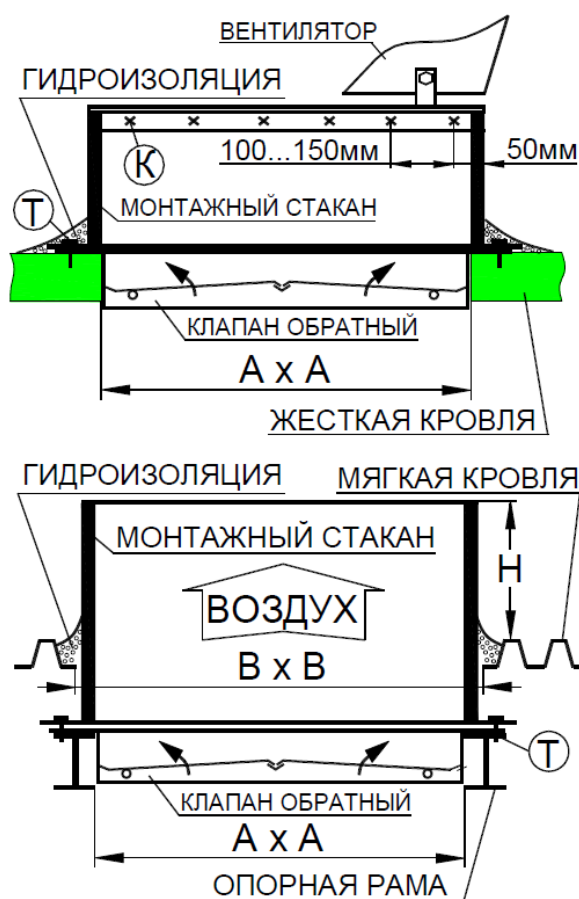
Монтаж на жесткой и мягкой кровле
